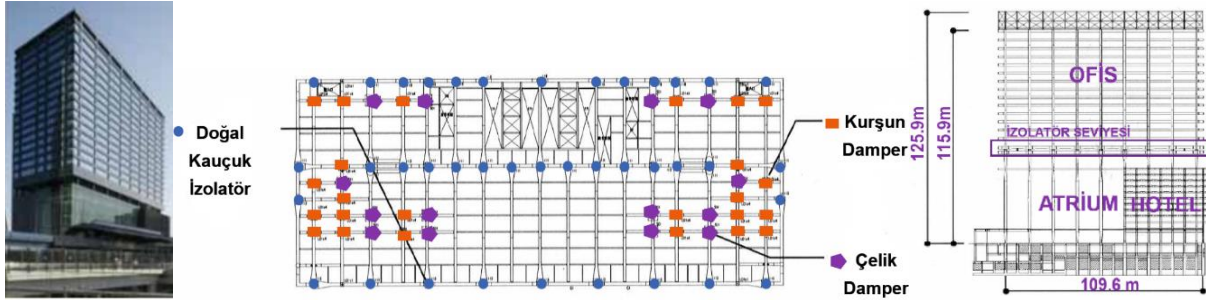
ldebashi First binası plan, kesit ve fotoğrafı (Tasaka vd., 2008; Tsuneki vd., 2008)
